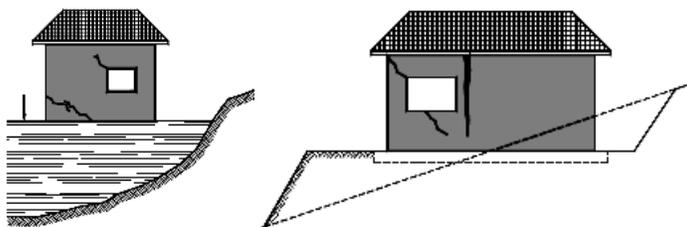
e 12: O trecho mais carregado apresenta maior assentamento, originando fissuras de corte no painel, e Sob as aberturas, fissuras de flexão
